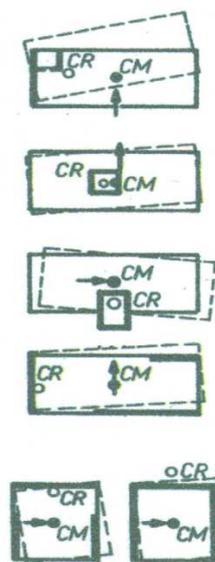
Distribución asimétrica de muros en planta (Paulay y Priestley, 1992)
